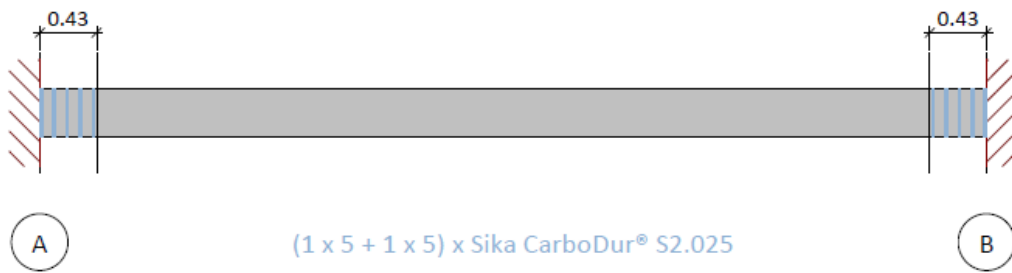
Reforzamiento en vigas FRP a cortante, Fuente: Propia
